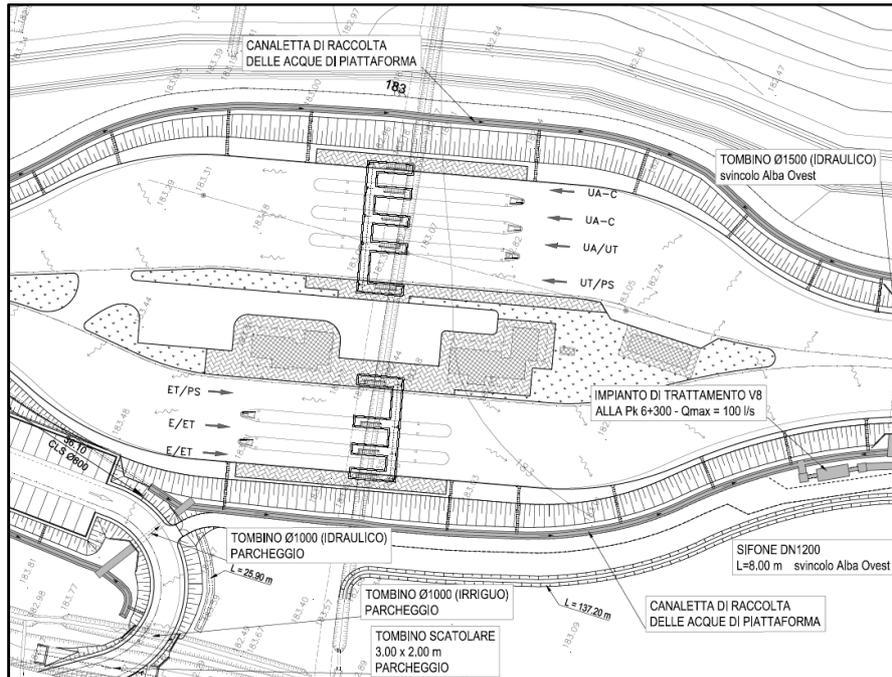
Stralcio Planimetria rete di drenaggio (elaborato 2.6E-d.C.4.1.11-01)
